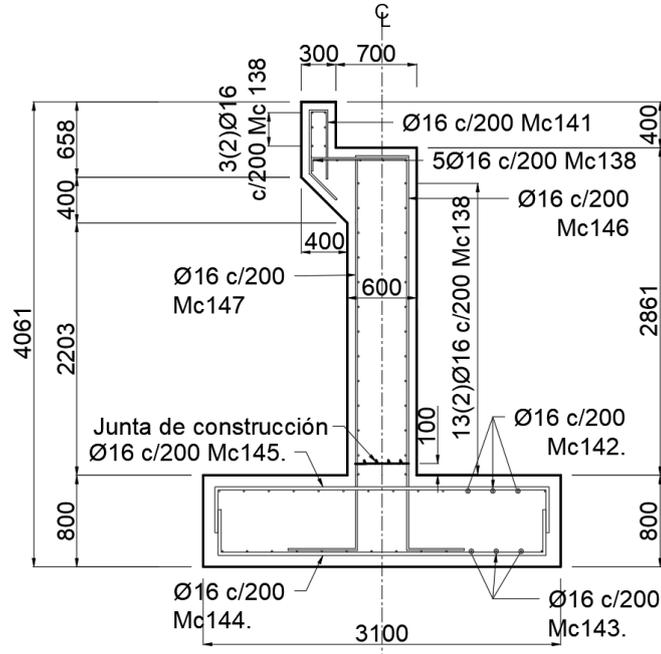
Armado de estribo 1 [Elaboración propia]
